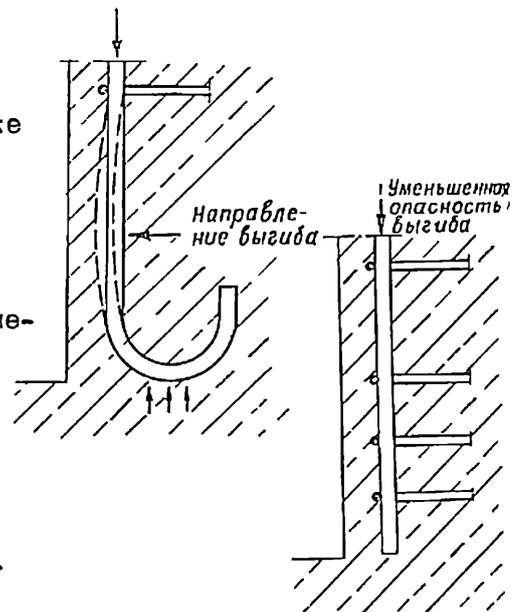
18. Крюки, особенно в колоннах, являются нежелательными для анкеровки стержней, работающих на сжатие
